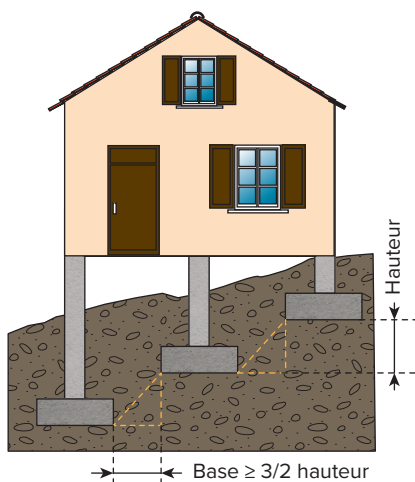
Dispositions des semelles dans le cas d'un terrain en pente
